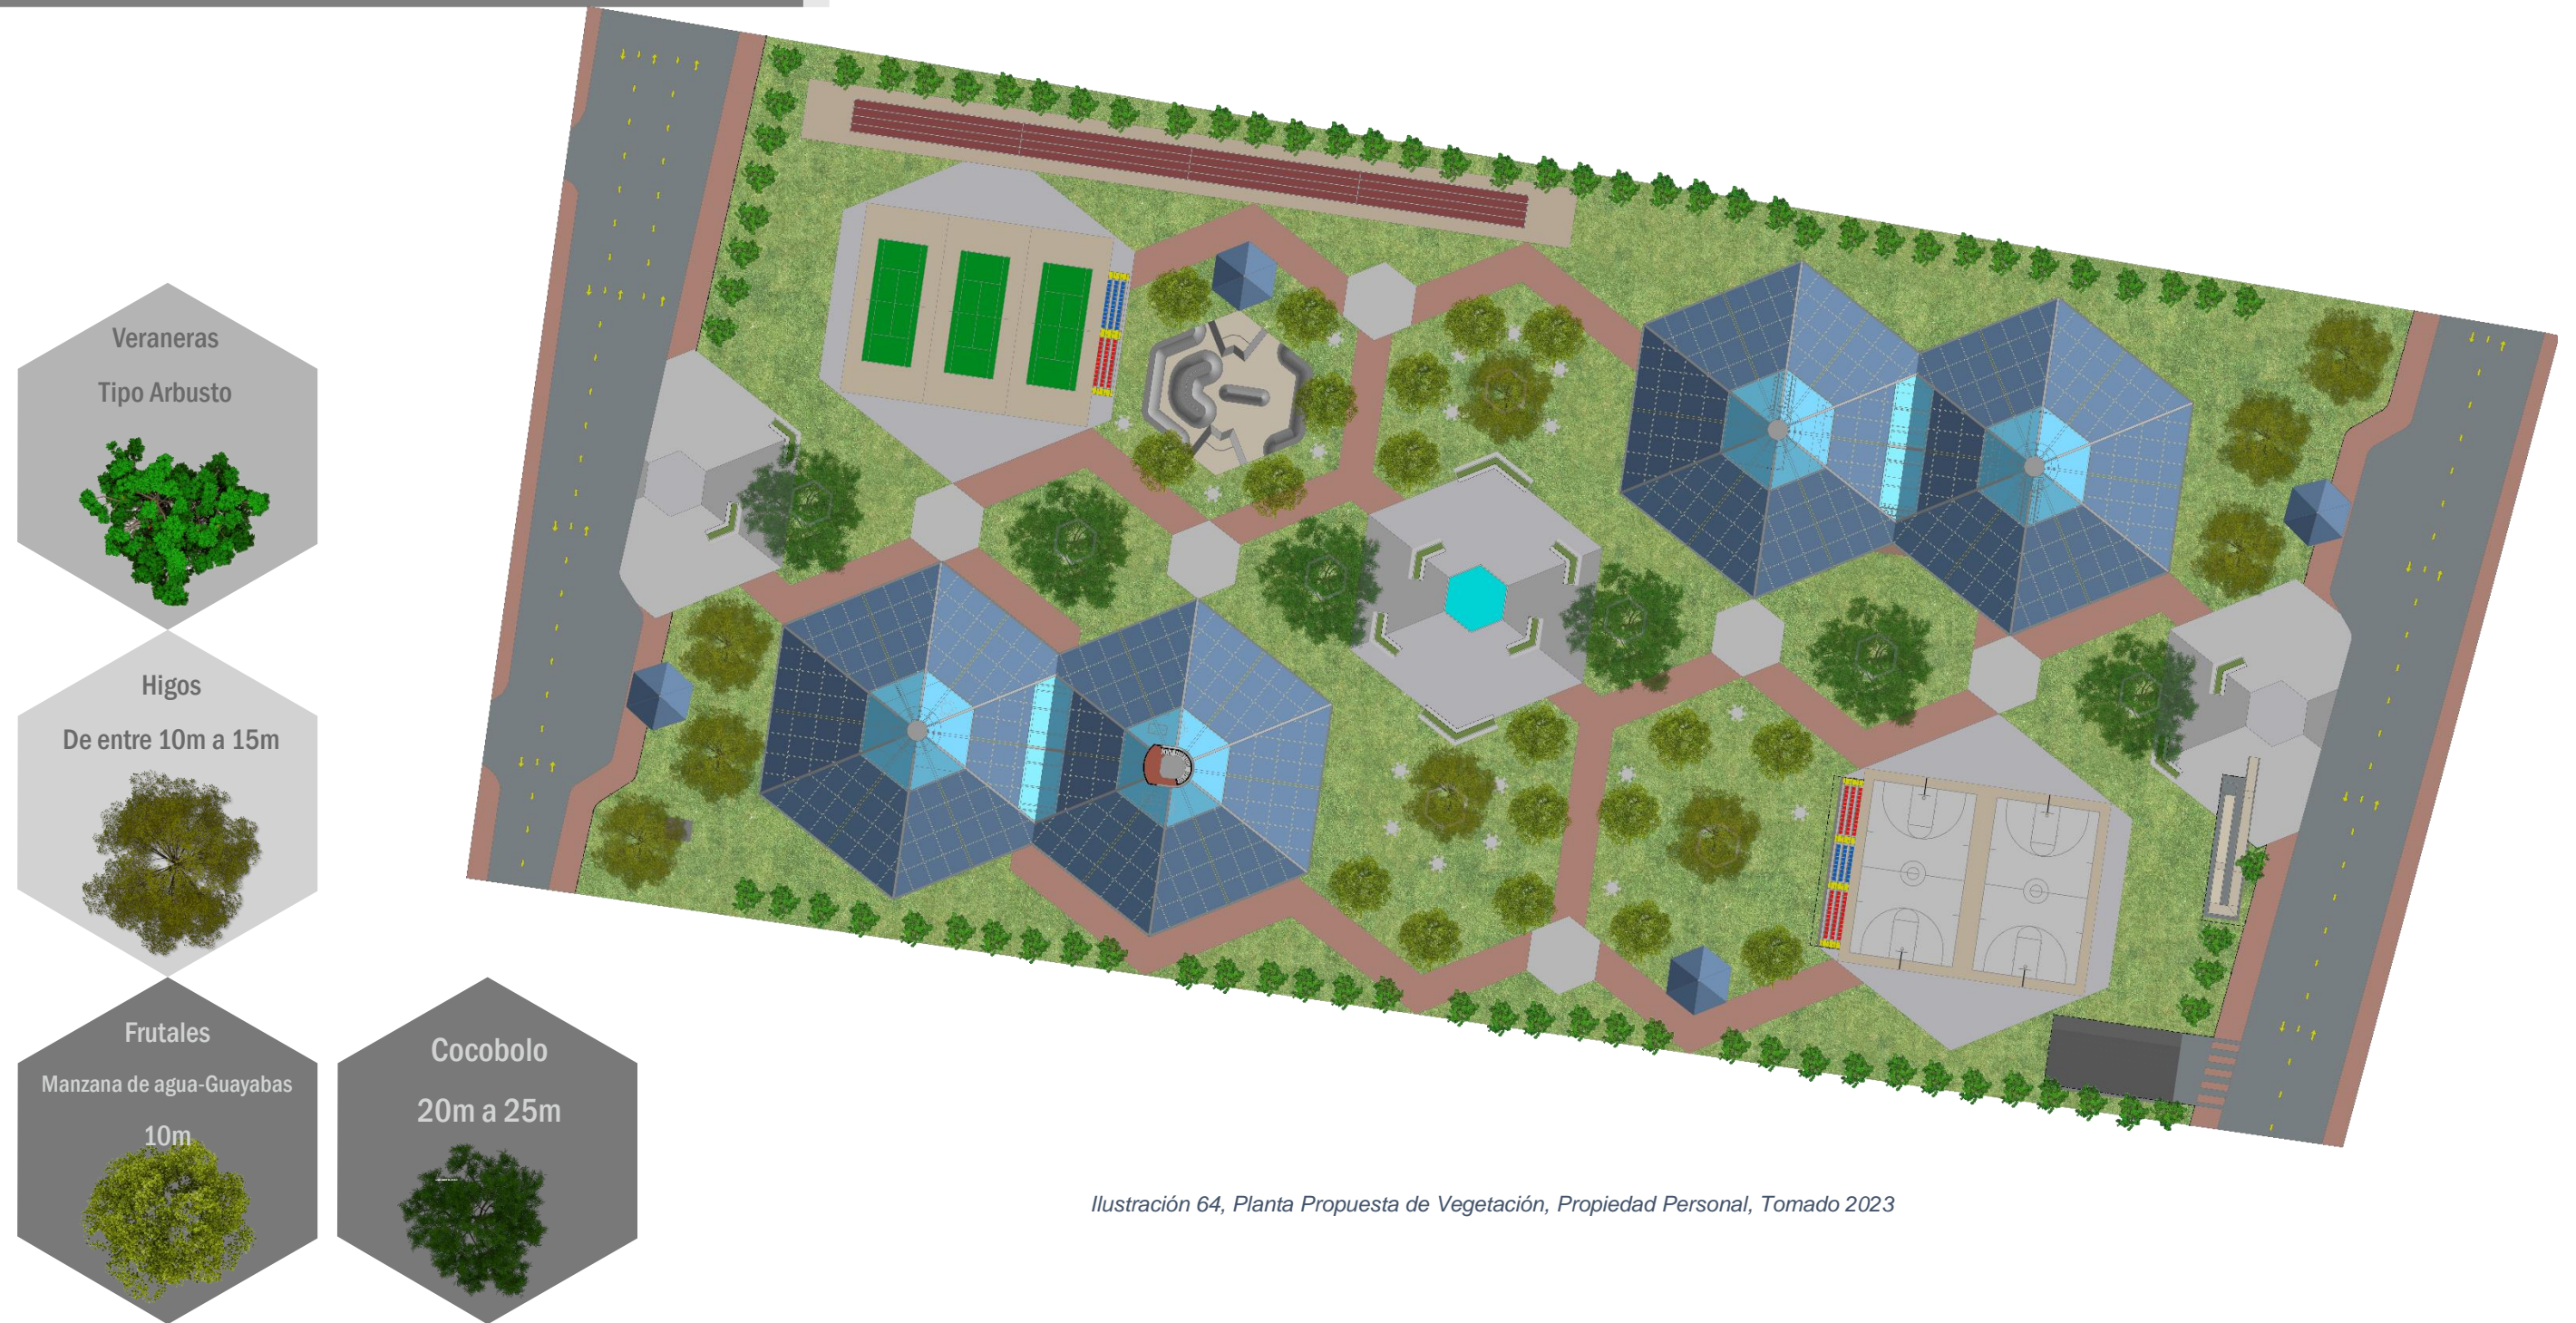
, Planta Propuesta de Vegetación, Propiedad Personal, Tomado 2023
